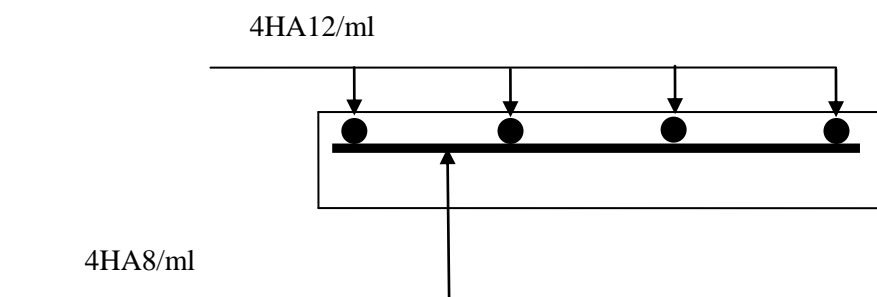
schéma de ferrailage de la dalle pleine sur 2 appuis
